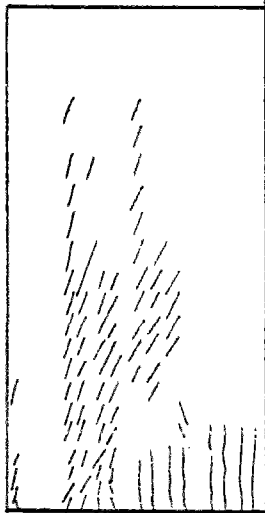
FISSURATION POUTRE CLOISON WT3 (SUITE)
